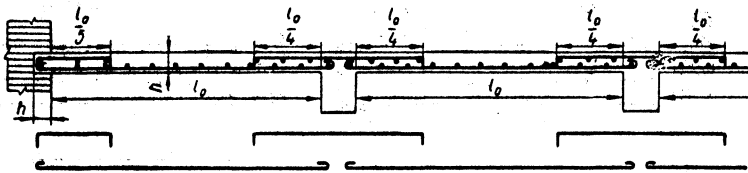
Схема раздельного армирования многопролетной плиты отдельными стержнями.
